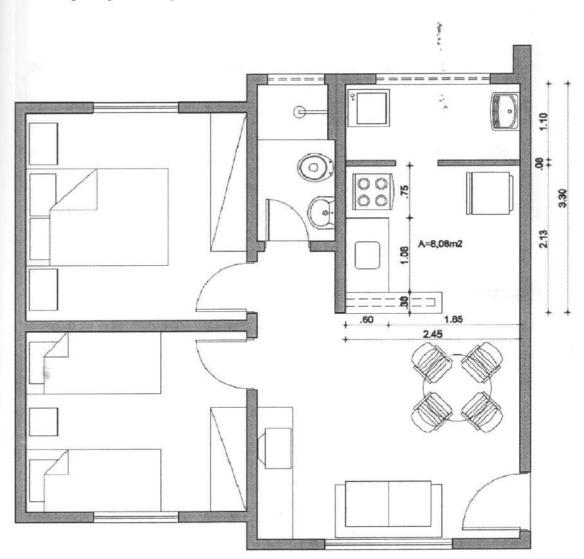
UH do Empreendimento A <u>antes</u> da aplicação das diretrizes propostas. (Fonte: adaptado de SAMPAIO, 2010)
